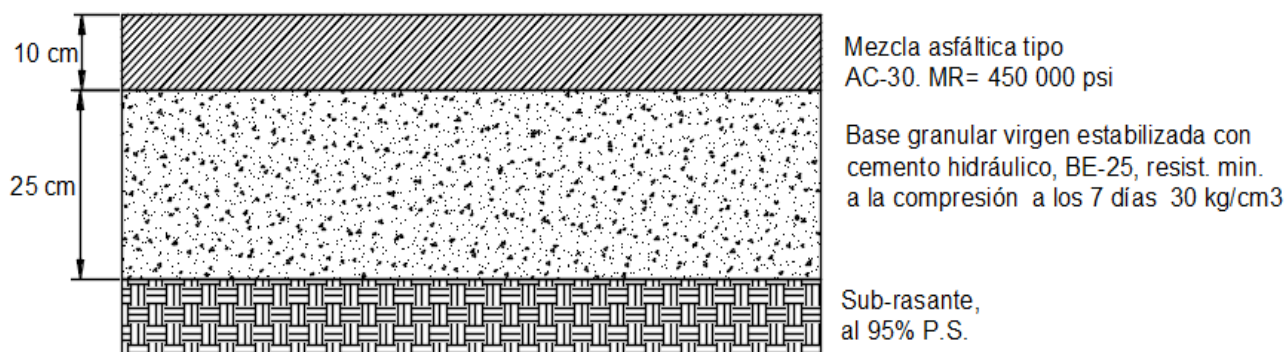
Perfil de la estructura de pavimento propuesta para el TH=28, 20 años.
